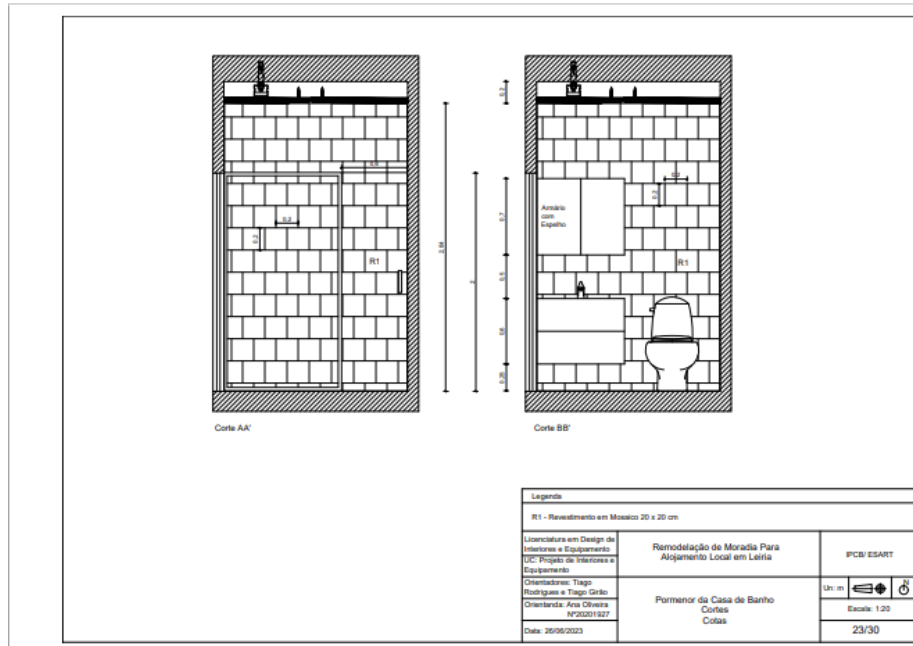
Cortes de Pormenorização, Casa de Banho, Piso 1 fonte a autora
